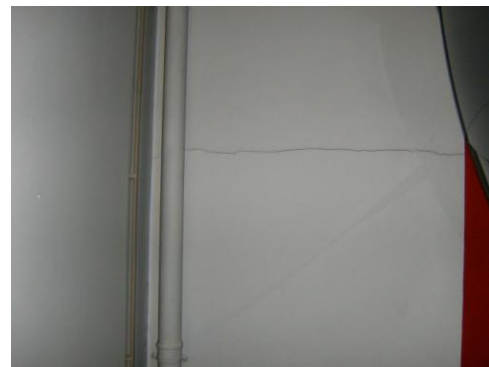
Fissuração nas paredes exteriores
